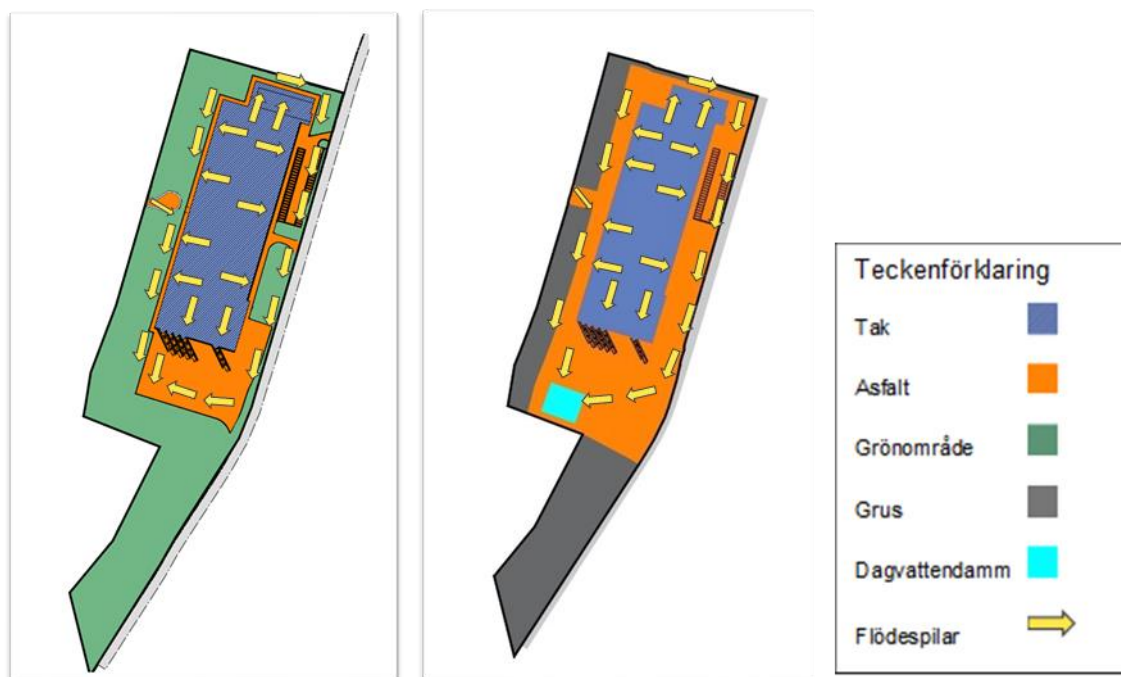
Förslag på sekundära avrinningsvägar inom fastigheten illustreras med gula pilar. Förslaget utgår från situationsplanen. Samma princip kan användas för exploatering enligt både alternativ 1 (vänster) och alternativ 2 (höger).
